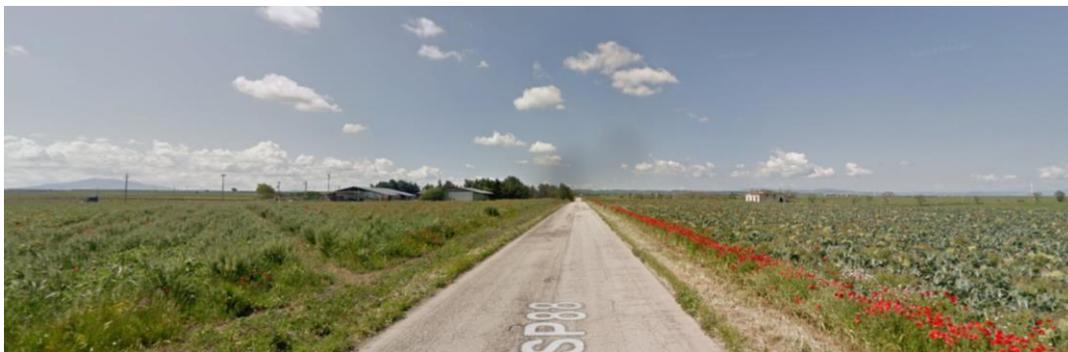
Attraversamento cavidotto interno in area di rispetto alla zona di interesse archeologico “ Lagnano da Piede” – SP88
